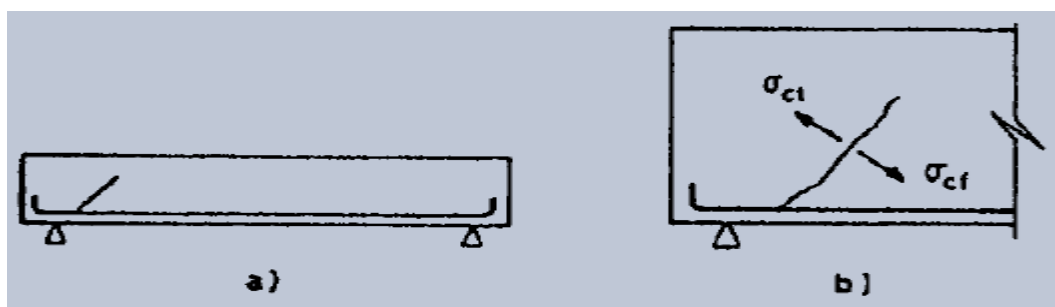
Fisura Estructural. Fuente Oyarzabal Schroeder
